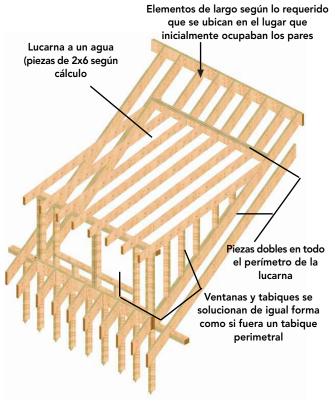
76: Lucarna a un agua que interrumpe los elementos estructurales del diafragma inclinado y que requiere de refuerzos en el perímetro donde se recortaron las piezas de la estructura de techumbre.
